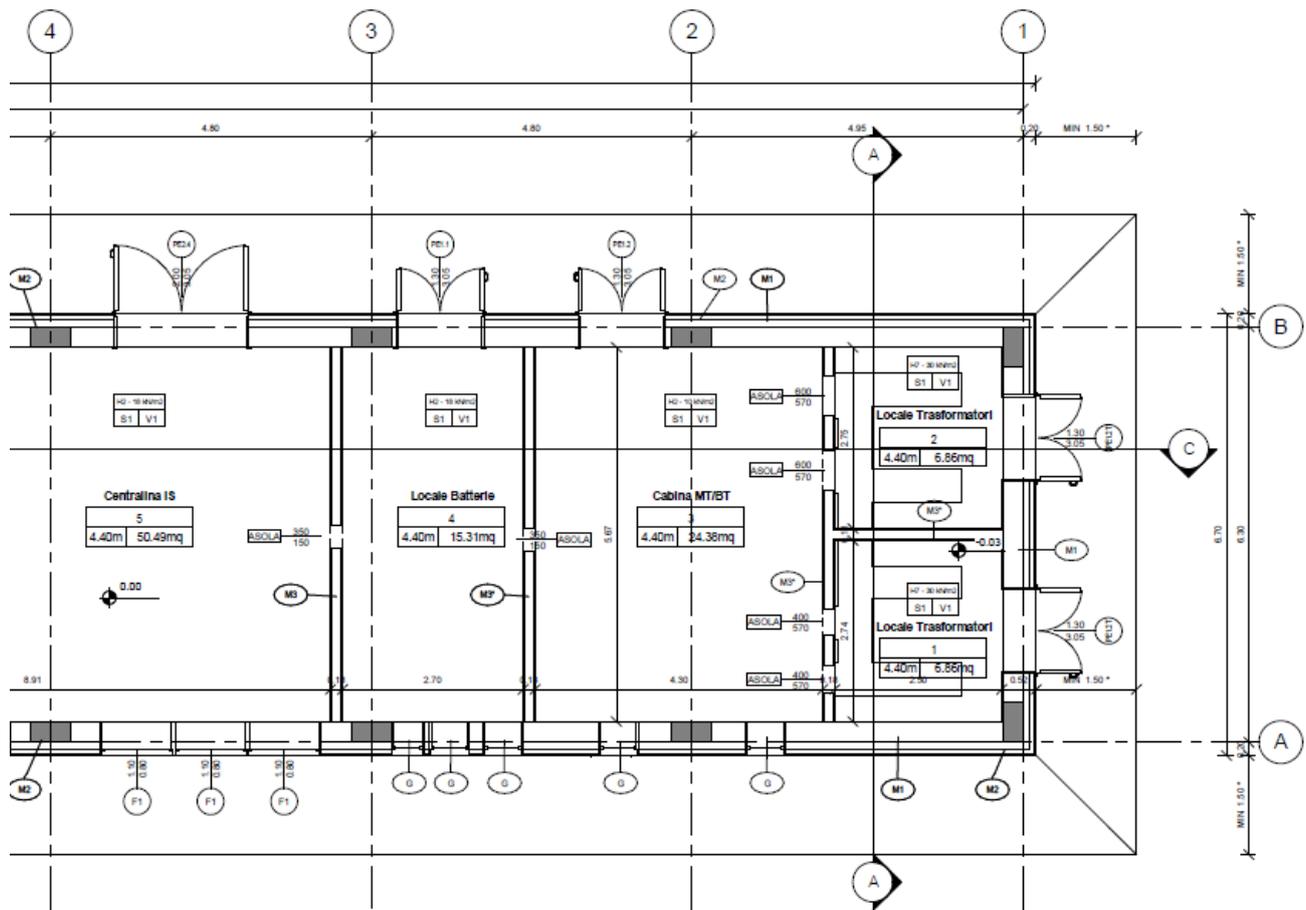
Pianta Architettonica Piano Terra T3_B
